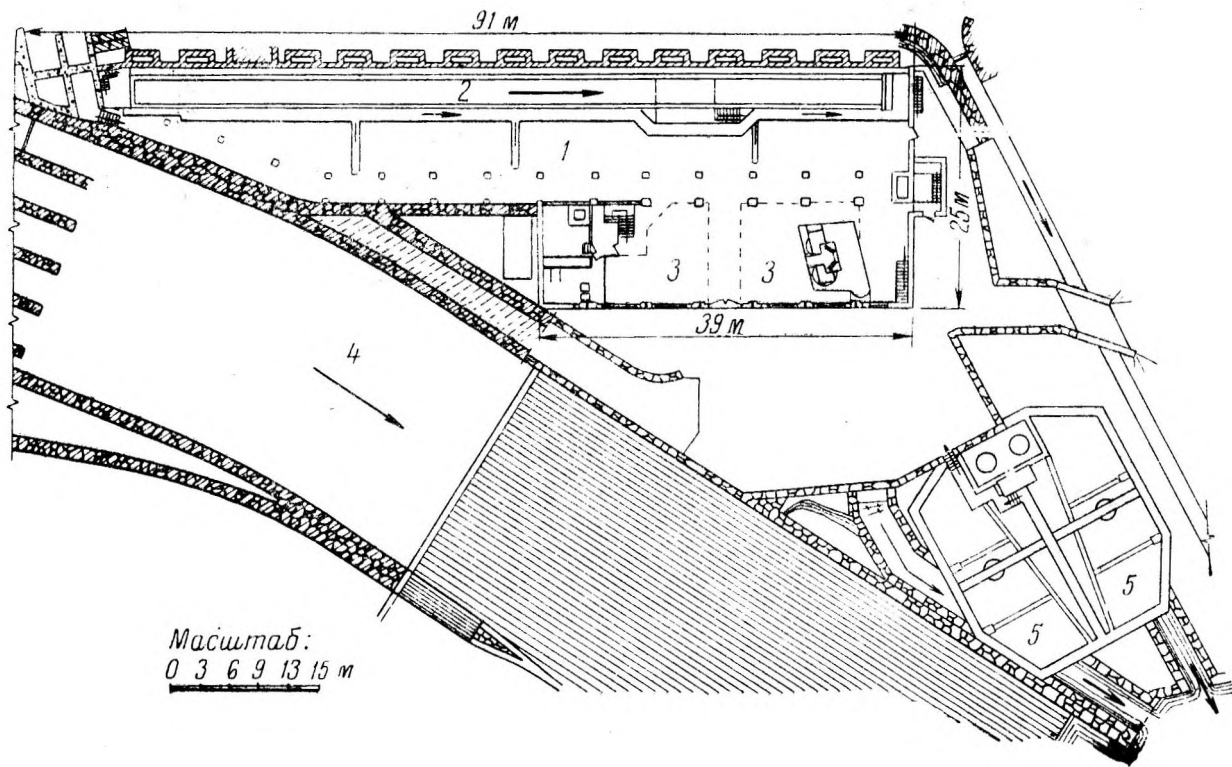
План главного лабораторного корпуса и прилегающих к нему сооружений
